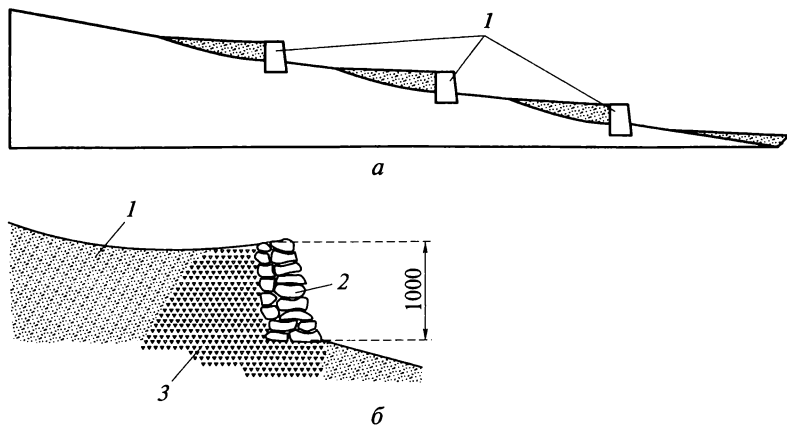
Простейшая конструкция подпорной стенки из камня:
